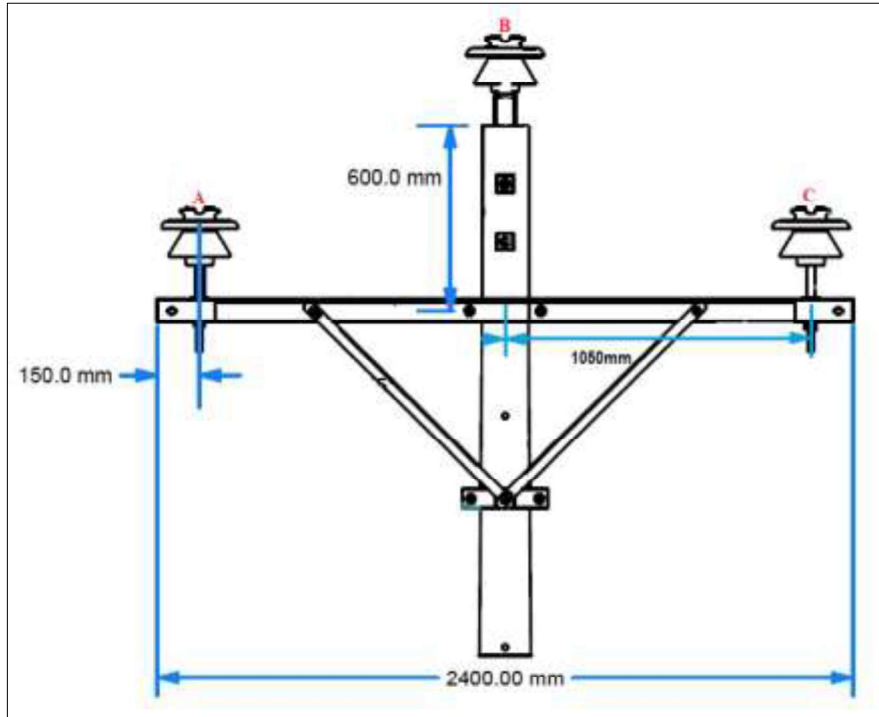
Tipo de armado AT1 y sin cable de guarda
